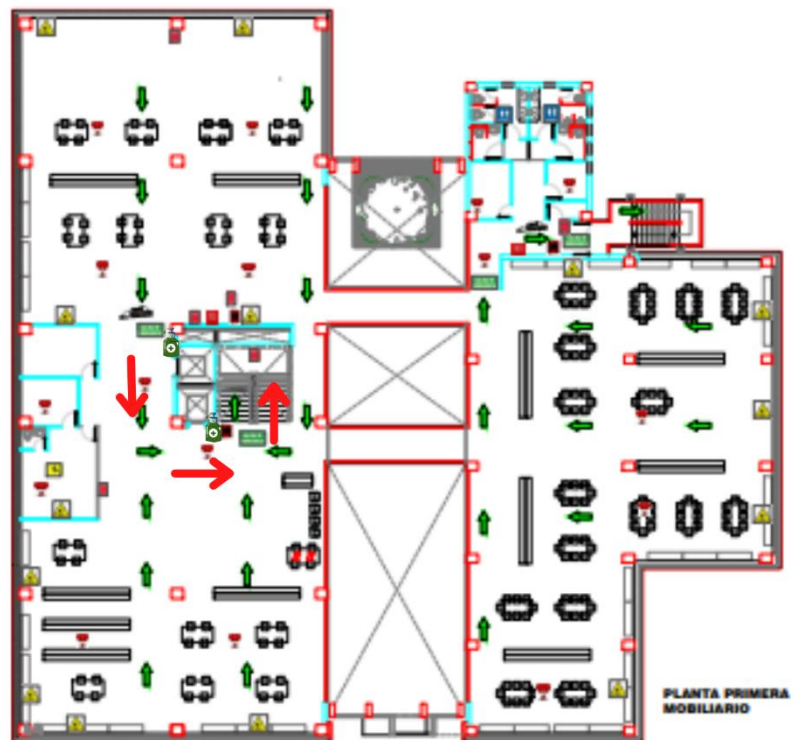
RUTA RECOMENDADA PRIMERA PLANTA ALTA CRAI
